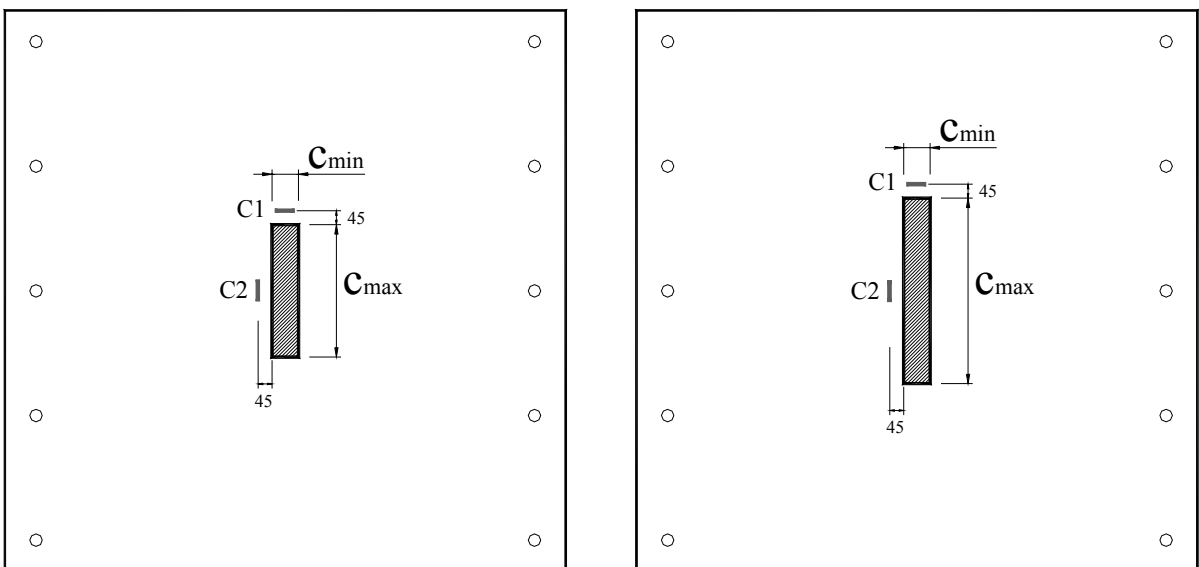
Pontos de instalação dos extensômetros na superfície do concreto das lajes com pilares de índices 5 e 7
